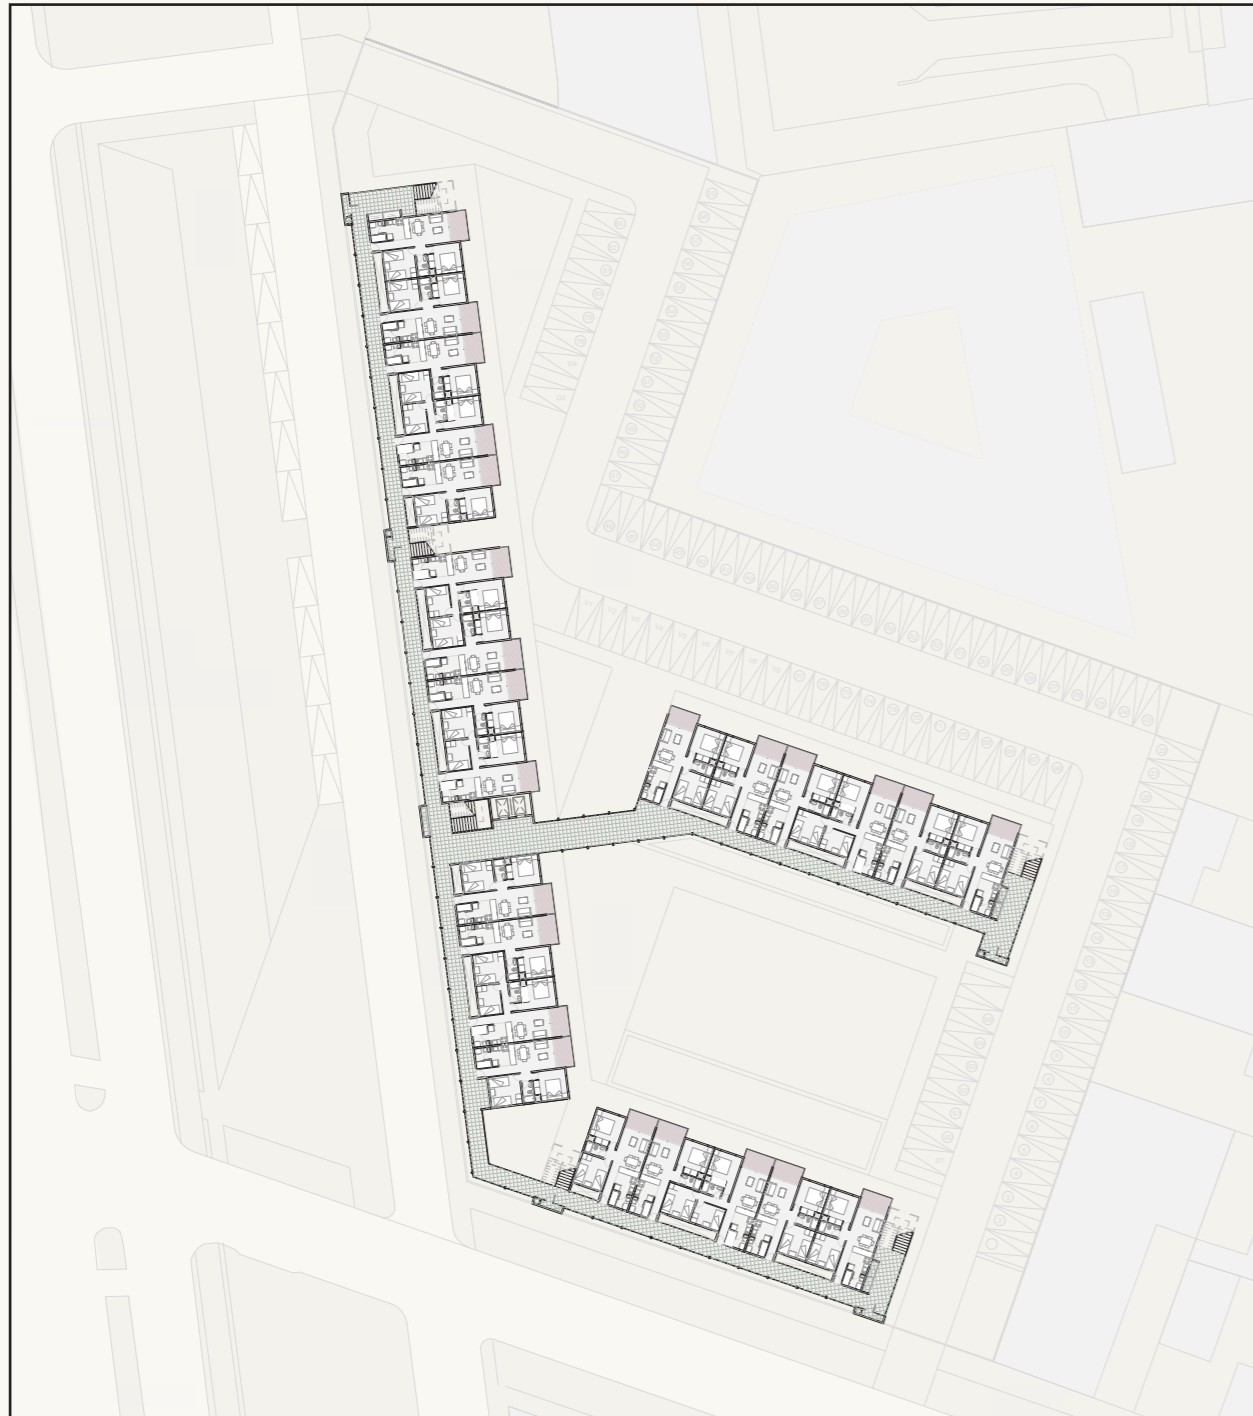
Planimetría nivel 3 | Fuente: Elaboración propia
